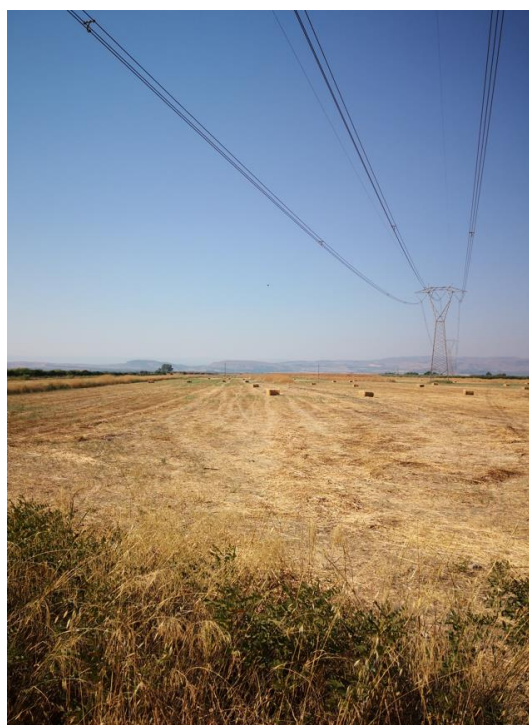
Ripresa da sud lotto di terreno nuova SE
